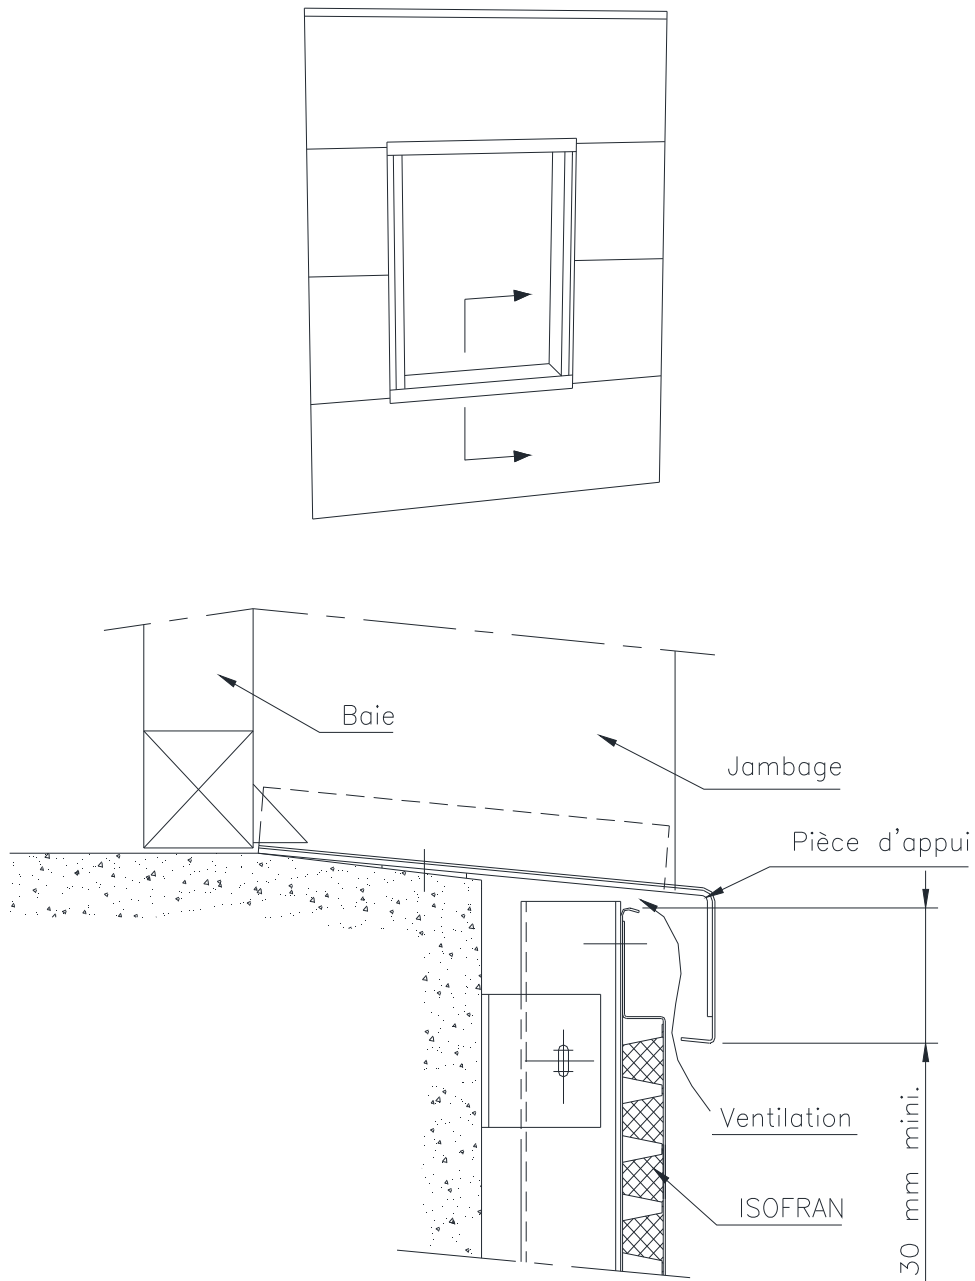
Panneau ISOFRAN Pose horizontale - appui de baie
